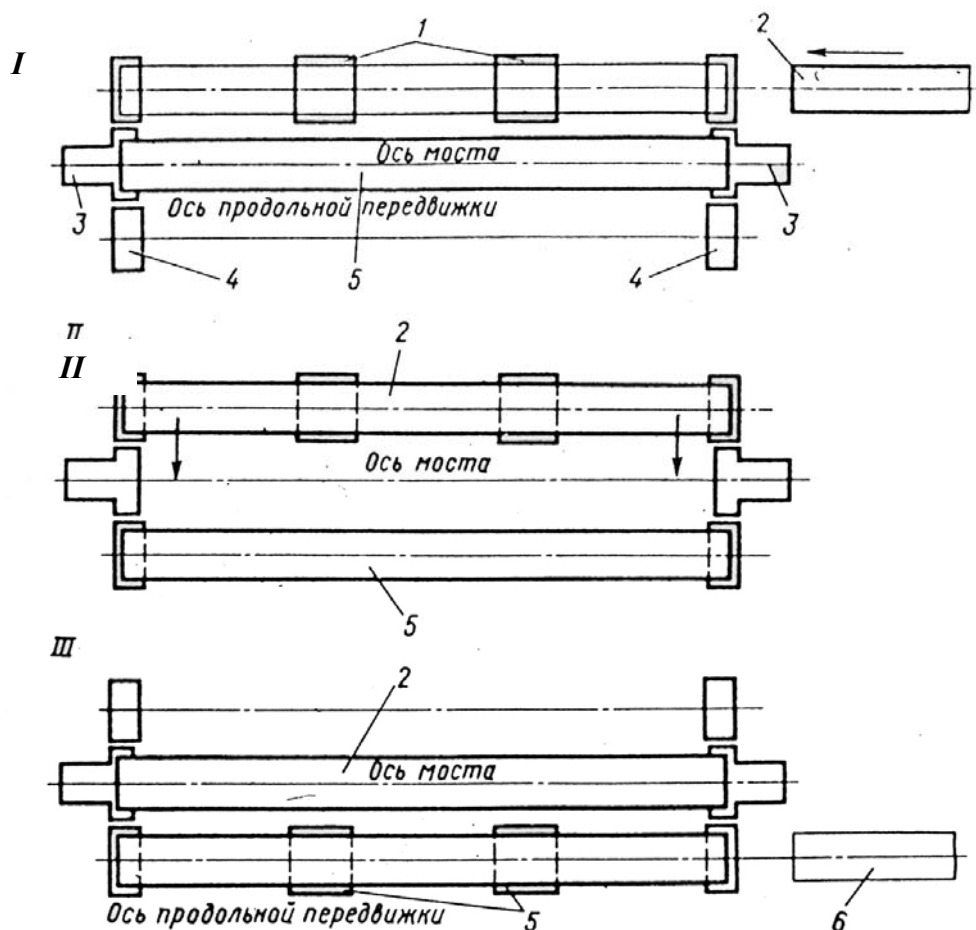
Технологическая схема замены пролетного строения методом поперечно-продольных передвижек: I – III – этапы работы; 1 – временные опоры; 2, 5 – соответственно новое и старое пролетные строения; 3 – устой; 4 – пирс; 6 – положение старого пролетного строения после продольной передвижки
